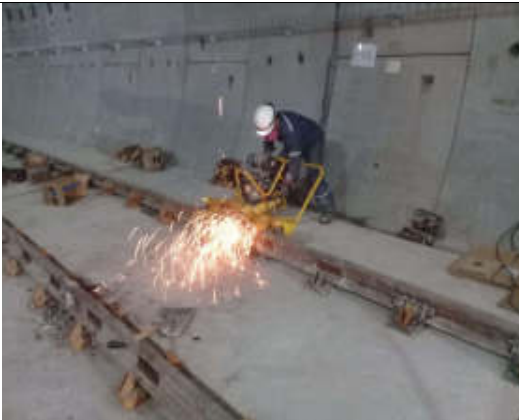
17-12-19. Soldaduras en el tramo de reposición de vía Solanda - Cardenal de la Torre.
